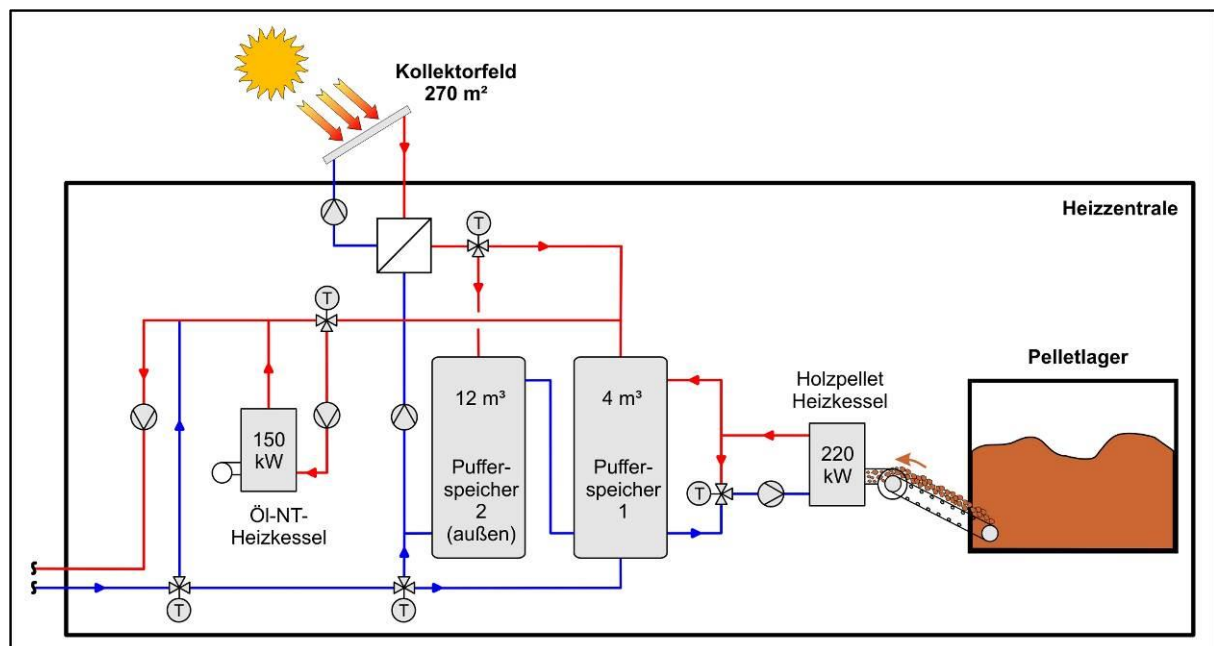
Anlagenschema Variante 6 – Holzpelletkessel mit Solaranlage 270 m²
